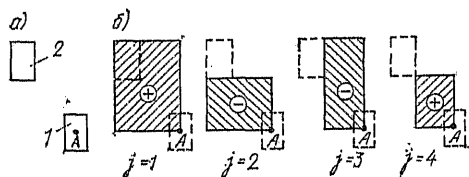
К определению методом угловых точек дополнительных вертикальных напряжений σ<sub>z,A</sub> в основании рассчитываемого фундамента с учетом влияния соседнего фундамента
